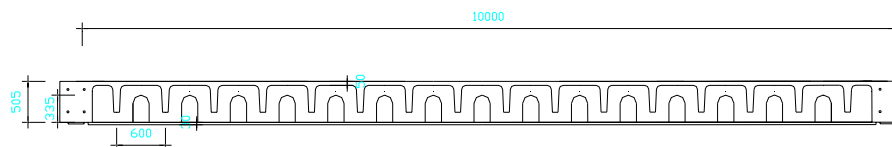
Coupe longitudinale - solution 10m - Dalle BFUP gaufree-échancrée et matériau composite
